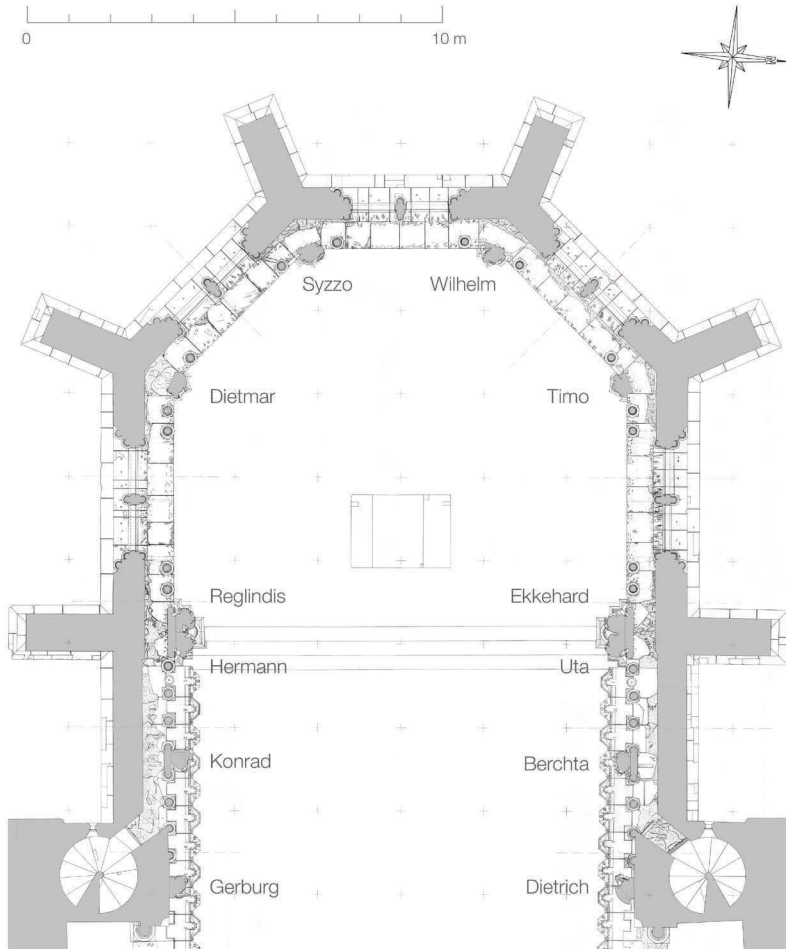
Grundriss des Naumburger Westchors auf Höhe des Laufgangs
